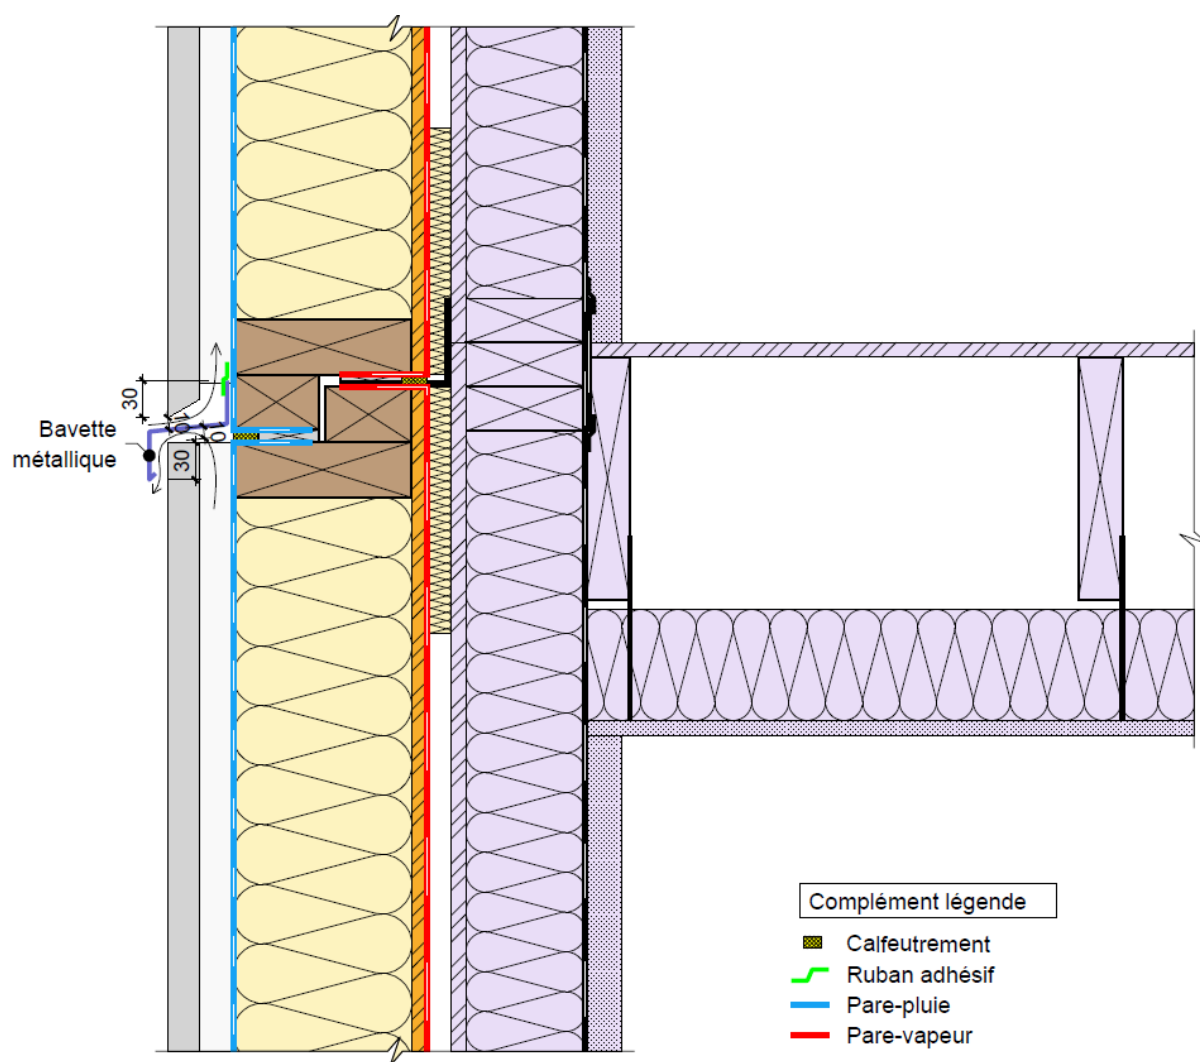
Plancher intermédiaire – avec recoupement de lame d’air du bardage (coupe verticale)
